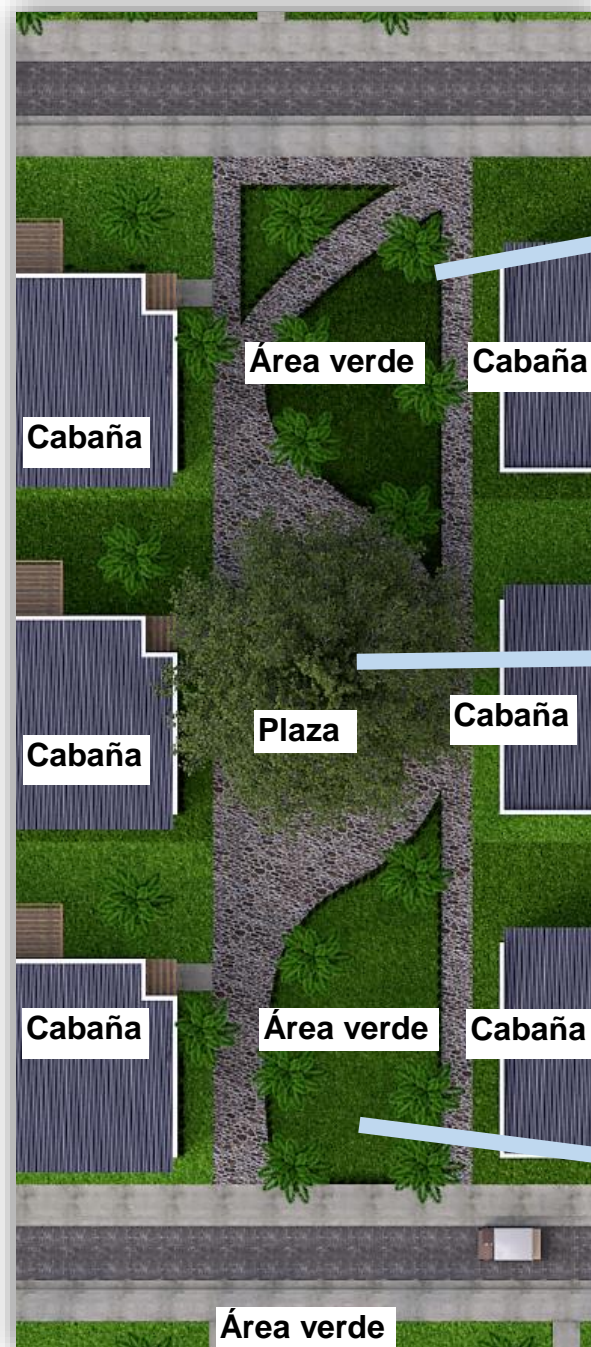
Vista en planta Fuente: Br. Alberto Payan Diseñador
